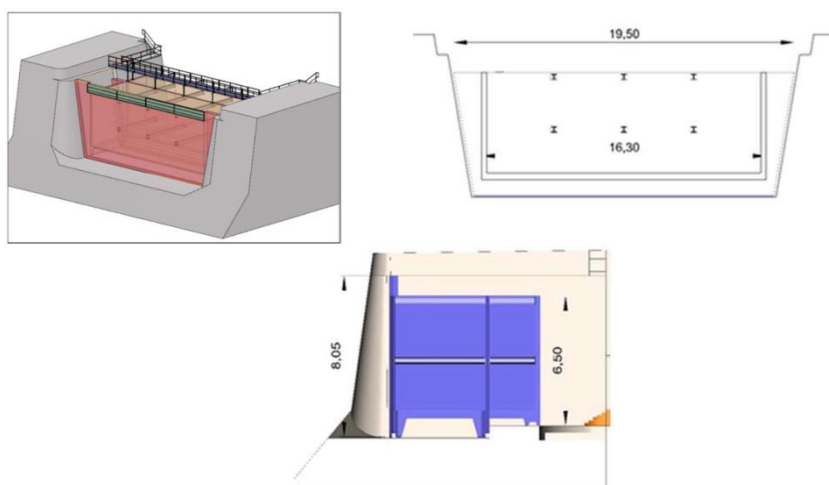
Projection du futur ouvrage en béton armé – obturateur de la forme N°7
